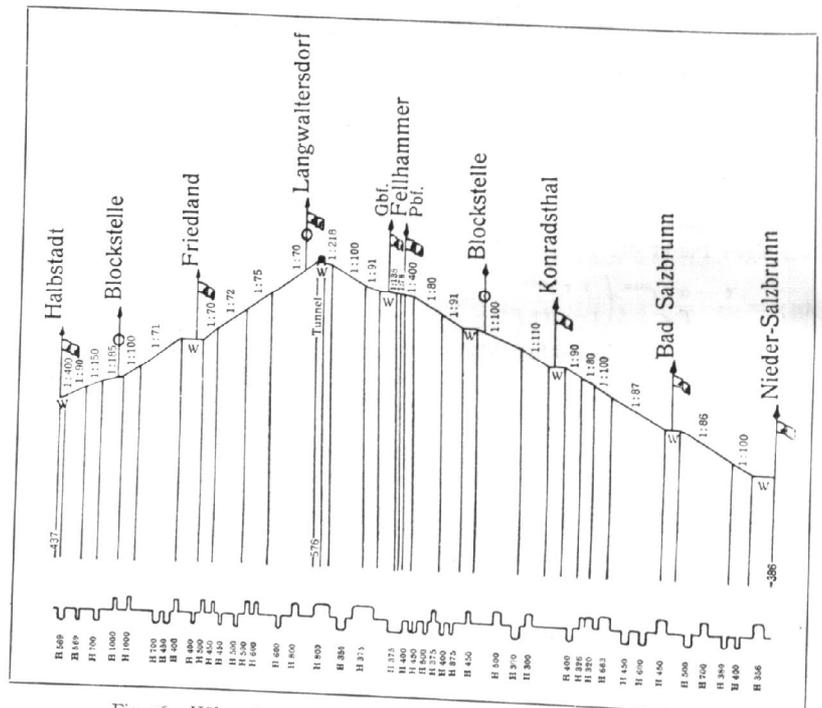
Höhenplan der Strecke »Niedersalzbrunn—Halbstadt«.
